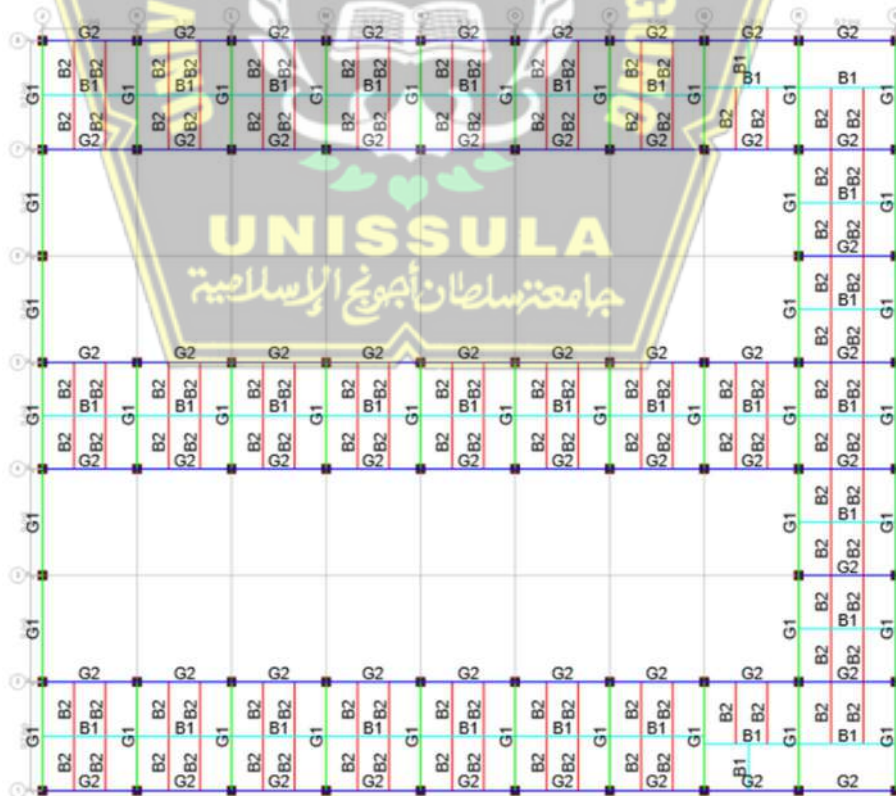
Denah Balok Lantai 1-3 Gedung A
